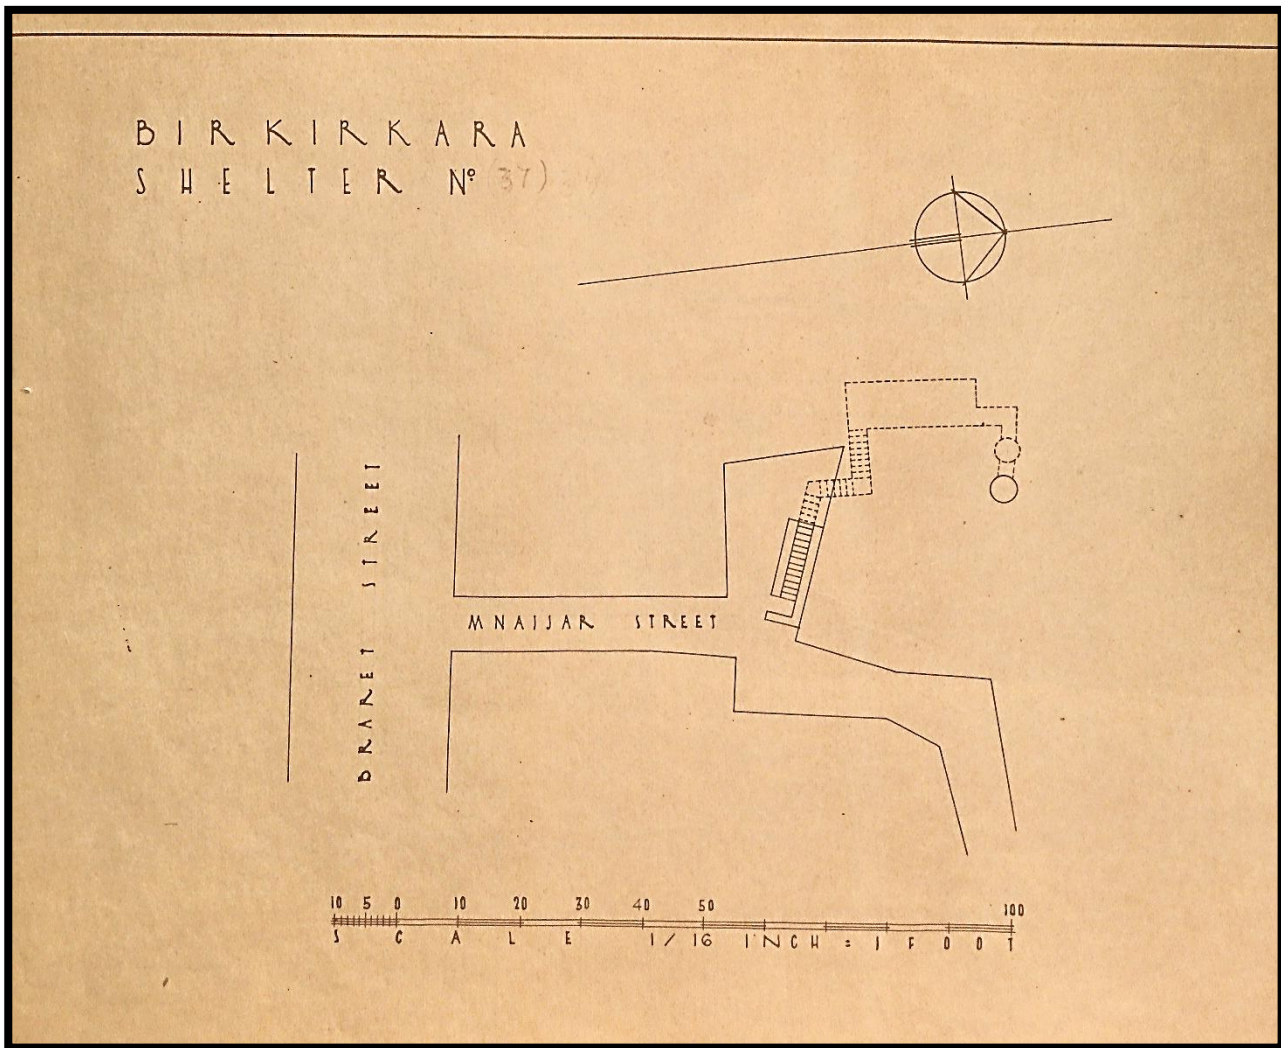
Planta do Abrigo nº37 "Braret Street – Mnaijar Street"
